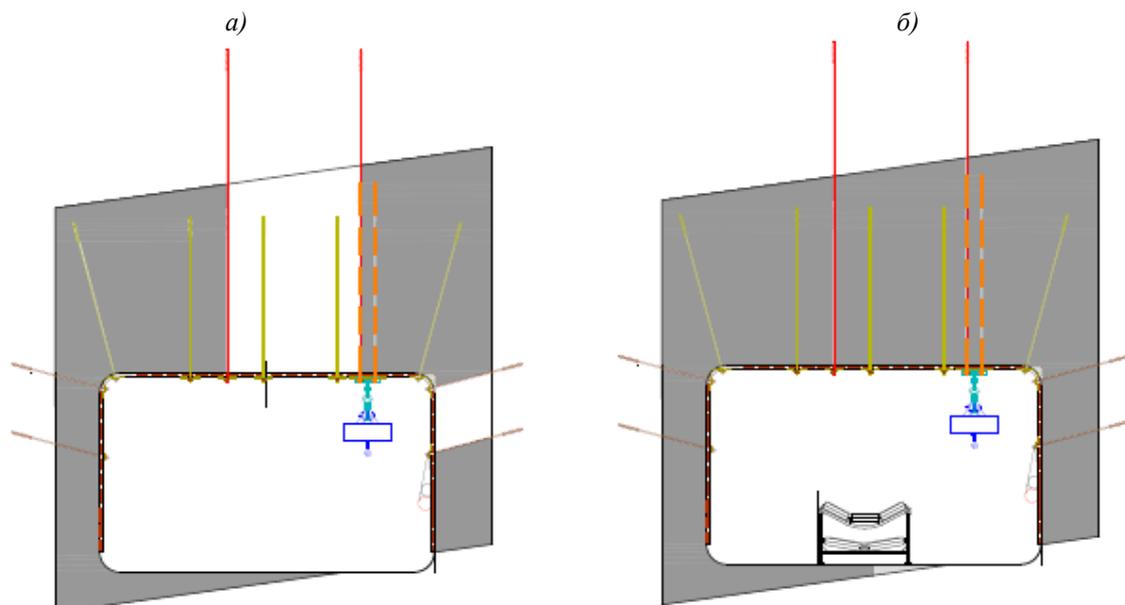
Потери в выпускаемом слое подкровельной пачки угля на сопряжениях с вентиляционным (а) и конвейерным (б) штреками
